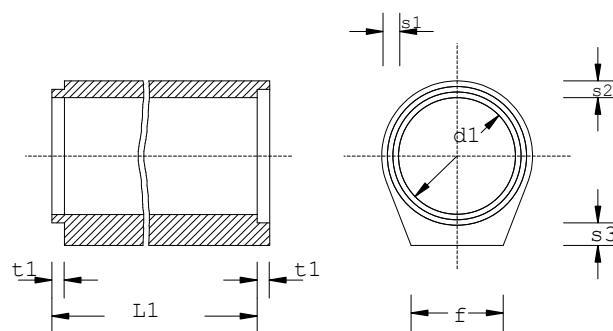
Tubi in calcestruzzo di sezione circolare con giunto a risega e piede
